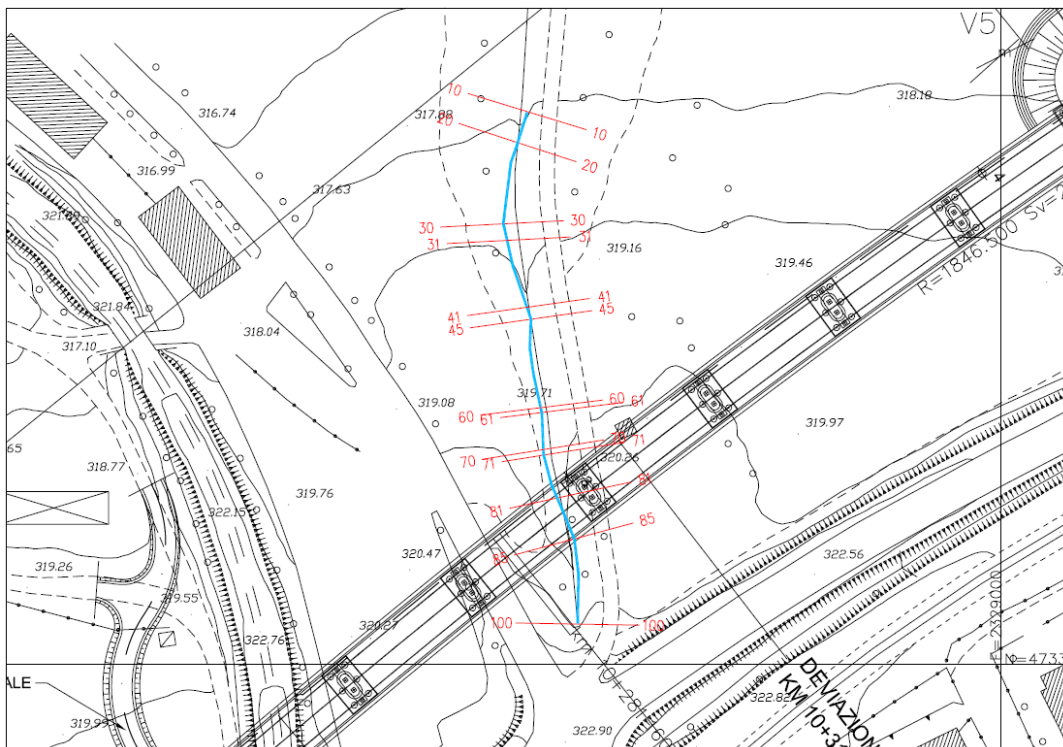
Planimetria dell'intervento e sezioni trasversali d'alveo del Fosso Sant'Antonio.
